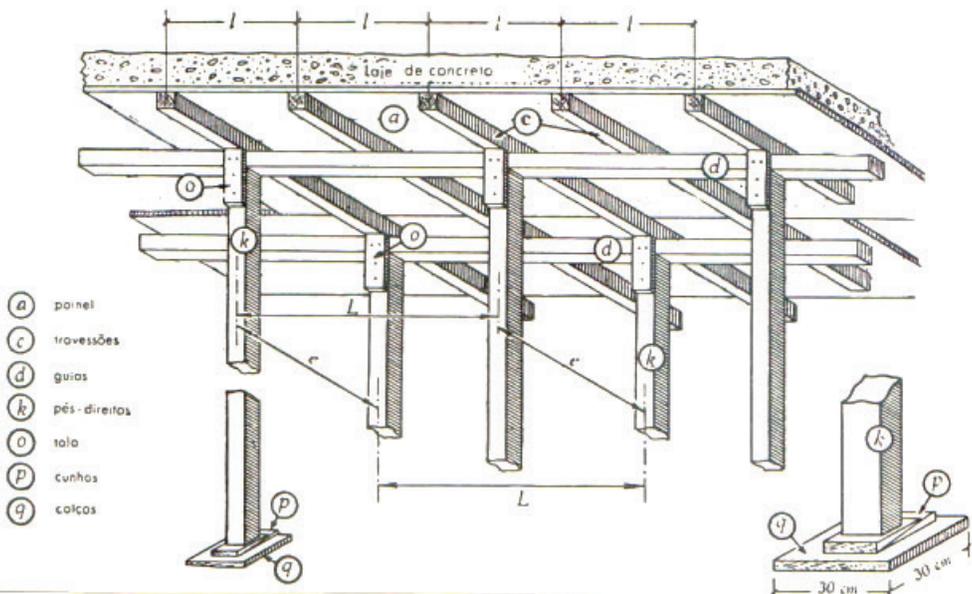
Esquema de fôrma convencional para laje, utilizando-se travessões e guias
